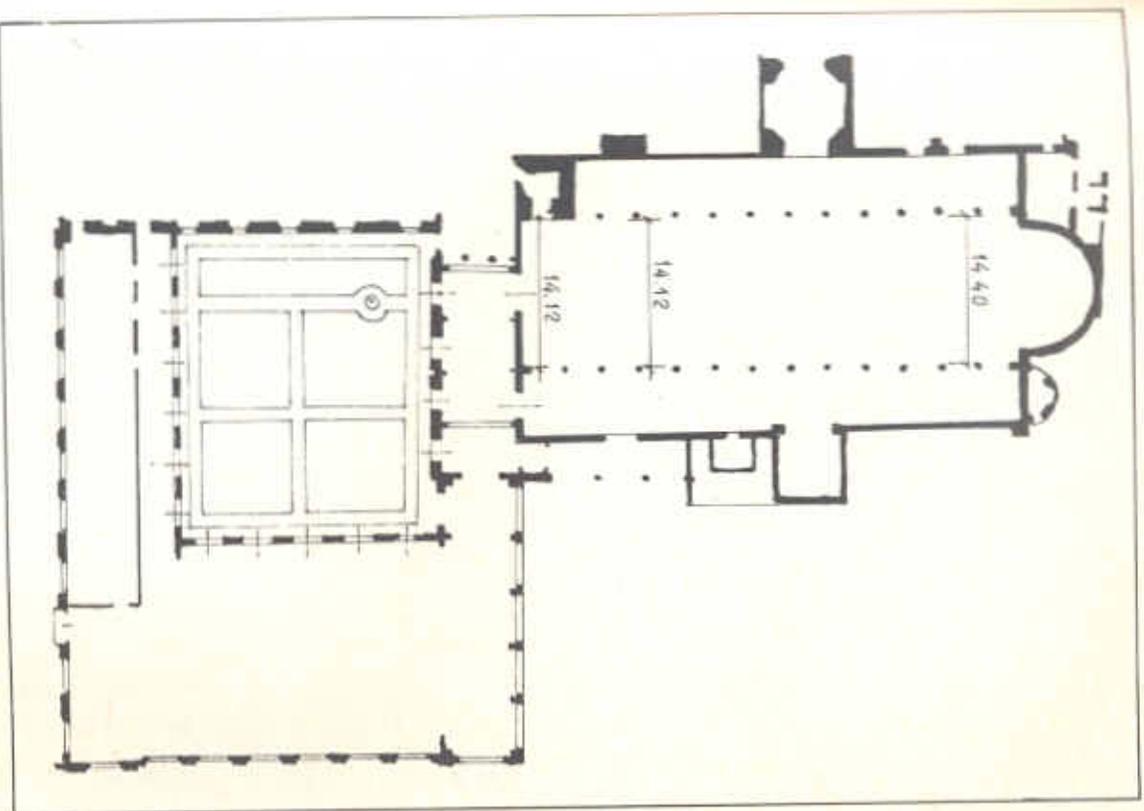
S. Sabina. Planimetria della chiesa e della zona antistante.
